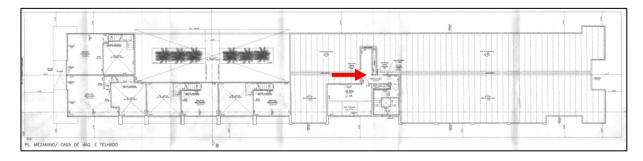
Laje de cobertura do sétimo pavimento. Destaque para trecho da estrutura degradada pela exposição às intempéries.
